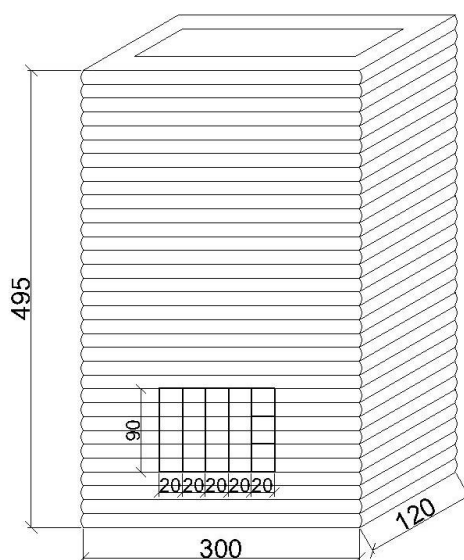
Схема 3D-печатной полноразмерной конструкции
